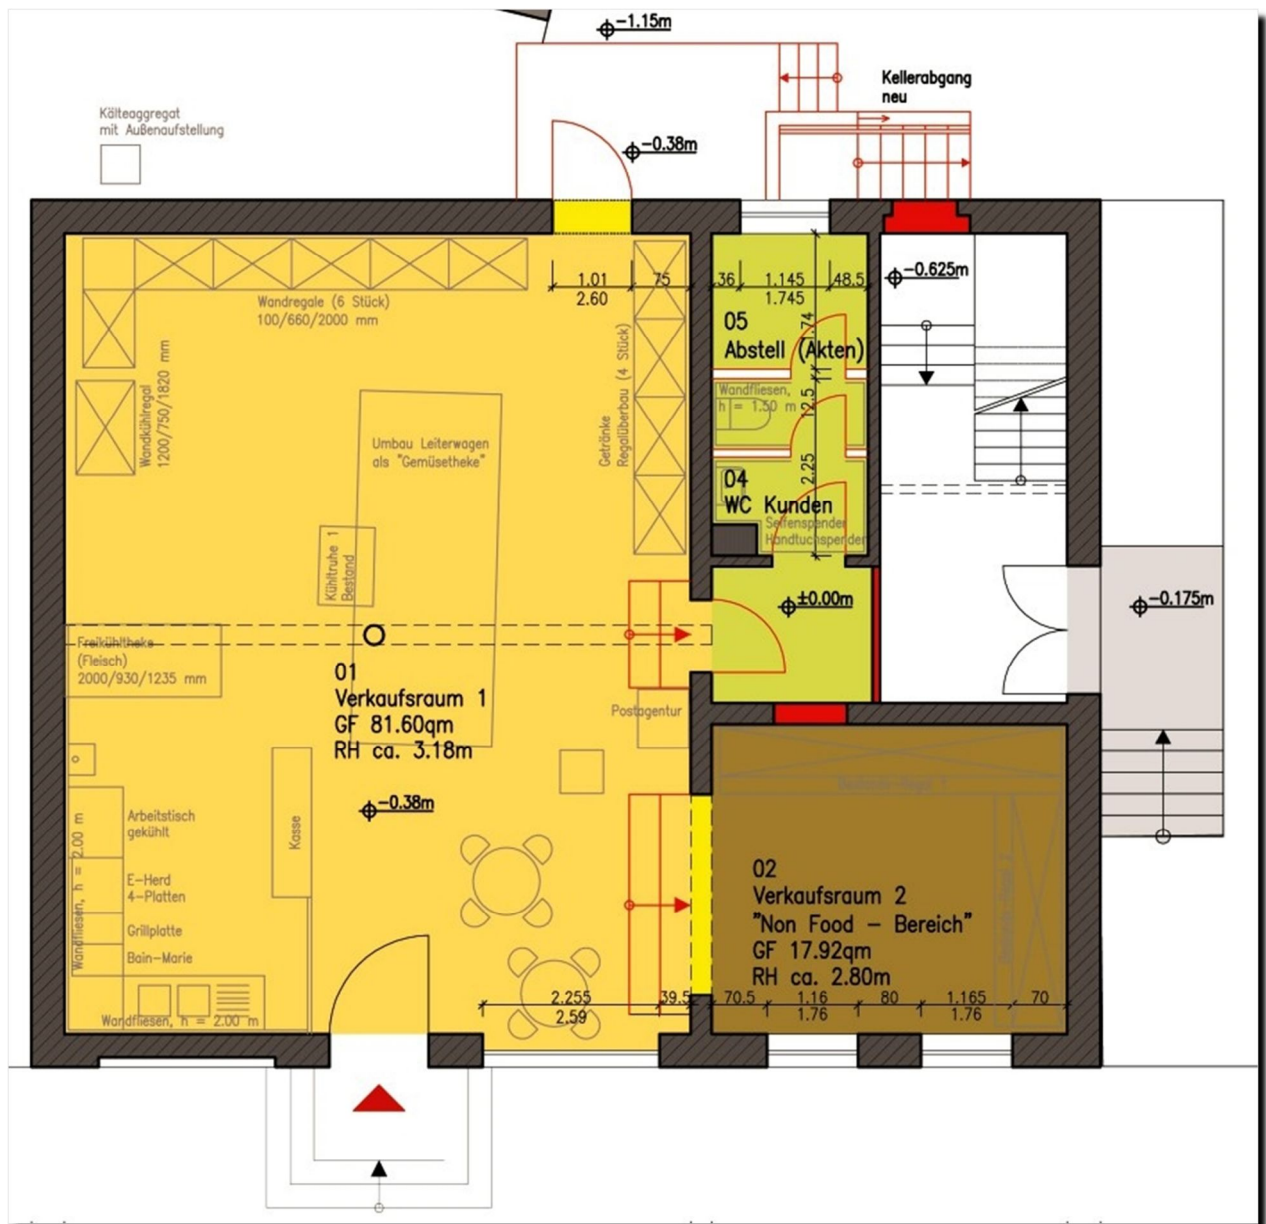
| Bauplanung Bauernmarkt Brunow / EG Grundriss (Phase II)
